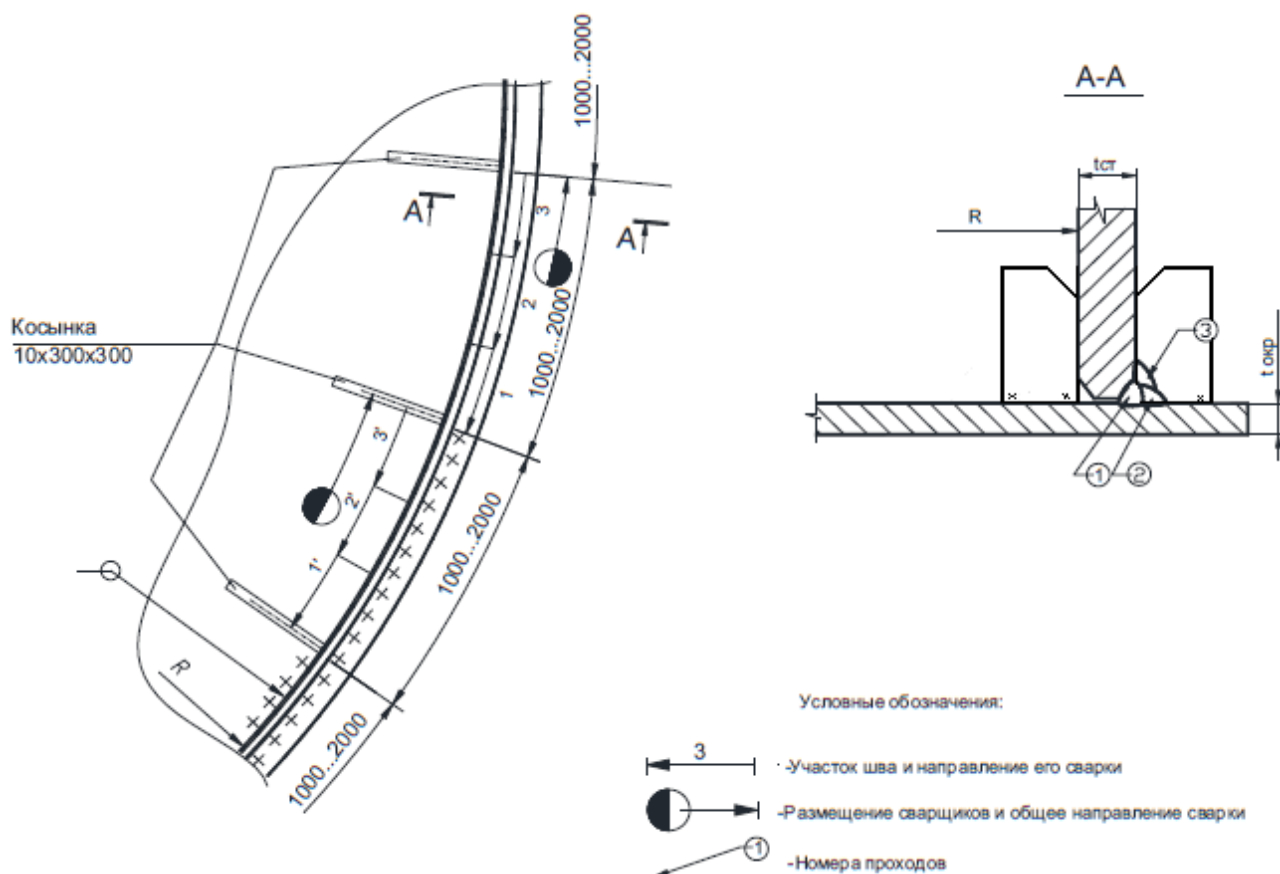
Схема выполнения уторного сварного шва
